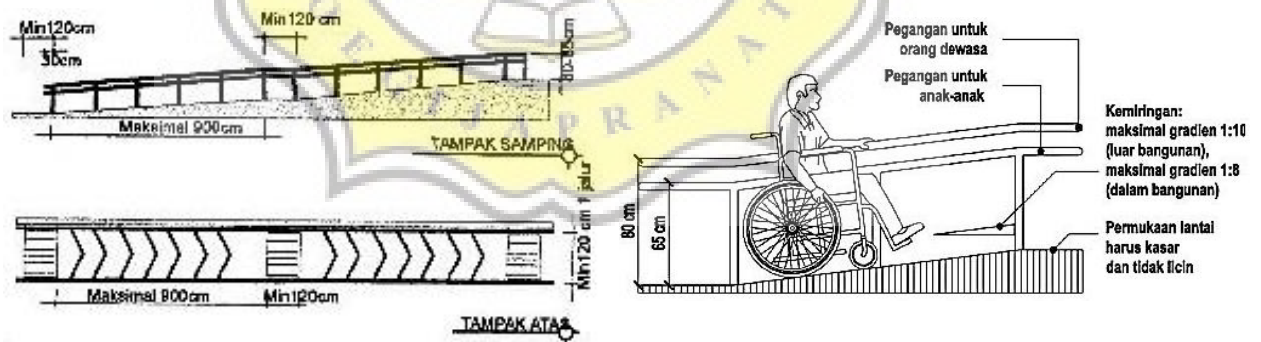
Kebutuhan Ruang Kaum Difabel
